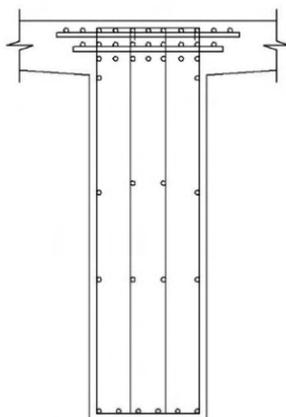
Reconstituição da Distribuição das Armaduras da Viga Original.
